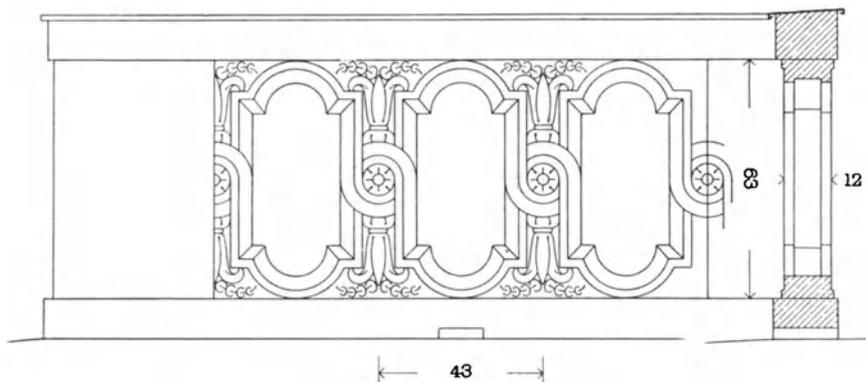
Balkonbrüstung vom Zeughause in Berlin. 1:20.
